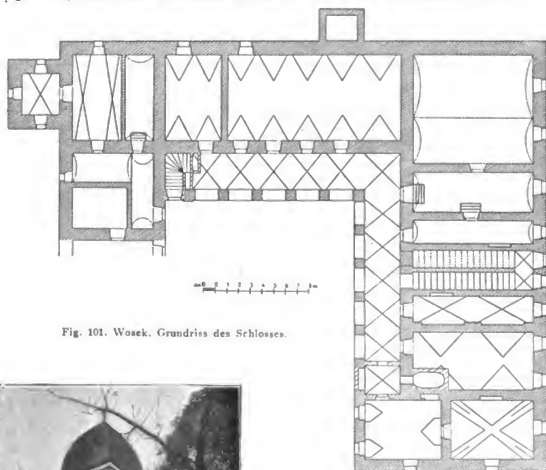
Wossek. Grundriss des Schlosses.
